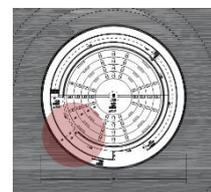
Vista da rampa de acesso ao piso -2 e entrada no Planetário.
